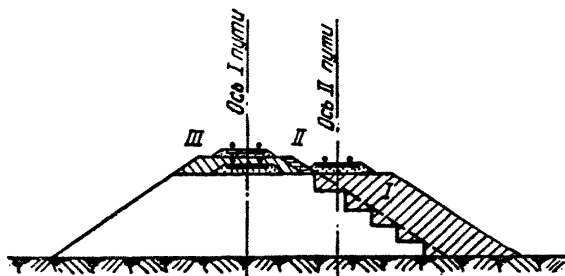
Схема отсыпки насыпи второго пути со срезкой верха существующей насыпи
